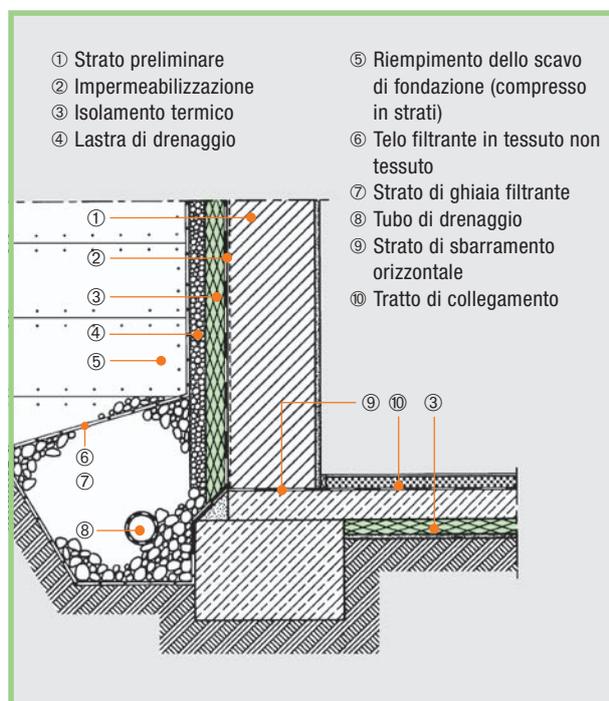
Struttura di un isolamento perimetrale combinato con un drenaggio.
